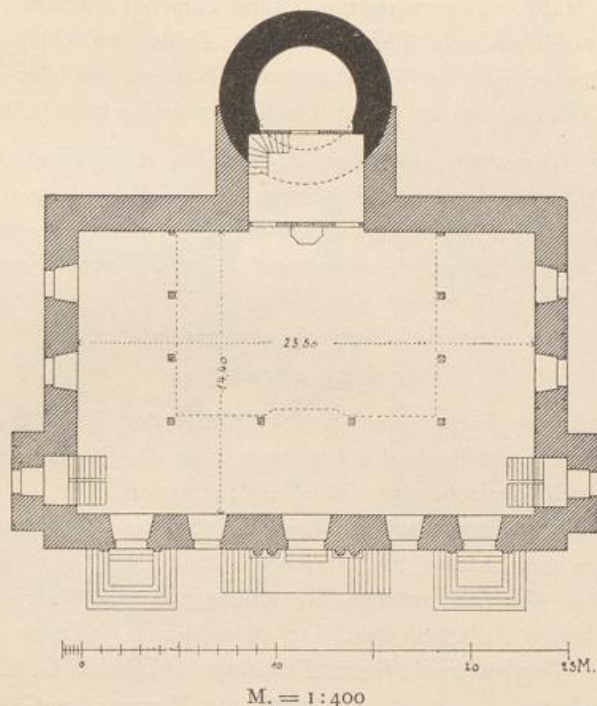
Wölfersheim. Grundriss der Kirche.
